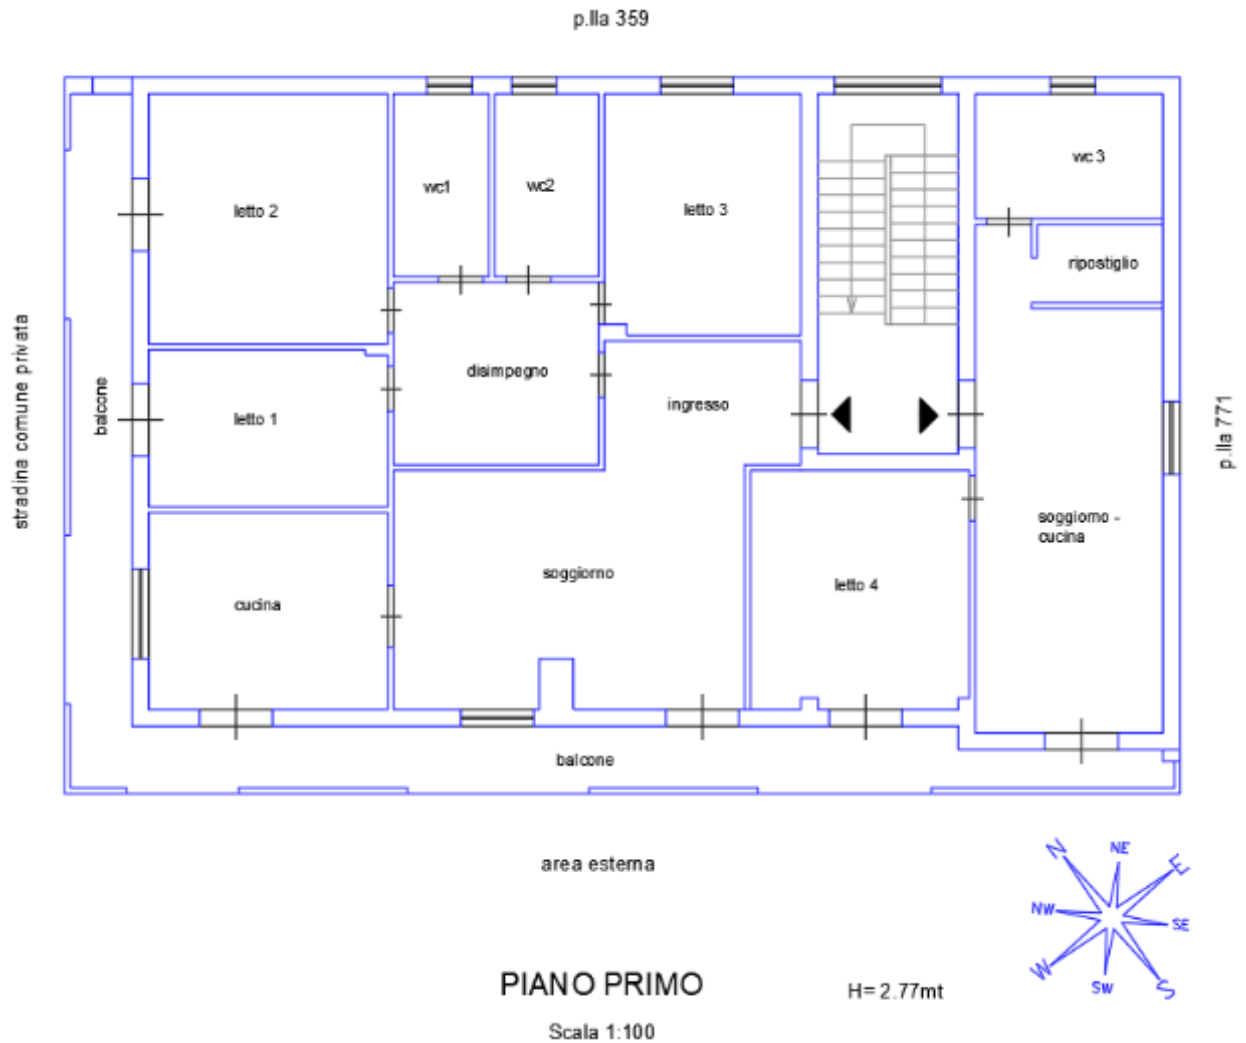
LOTTO 1 - planimetria appartamento piano primo
